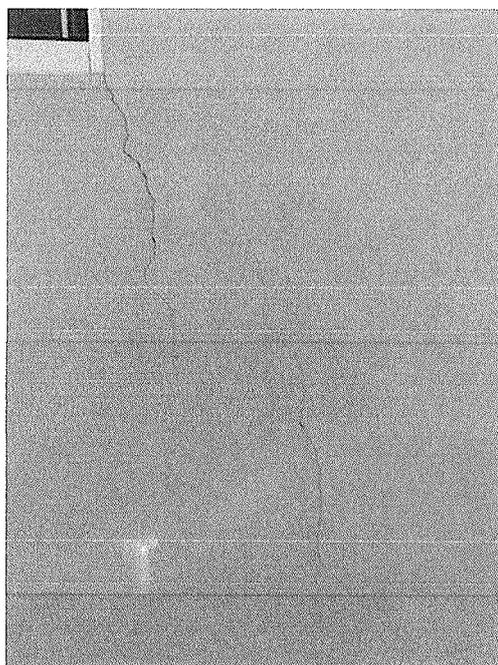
Trinca na parte externa da edificação por causa do movimento da viga que flambou
